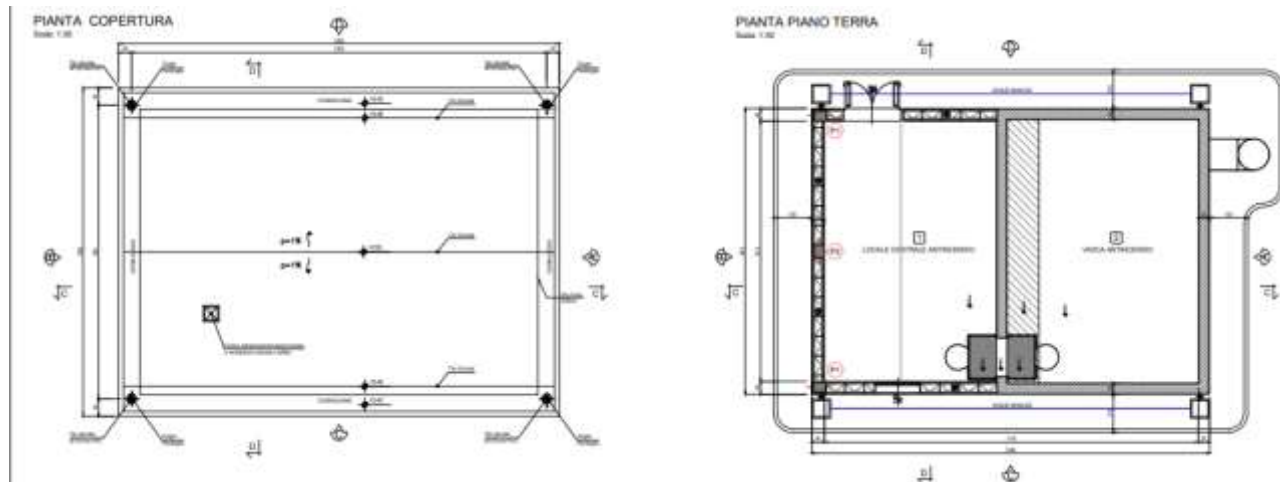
Pianta di copertura (a sinistra) e piano terra (a destra) - Fabbricato FAVL – progetto in variante
